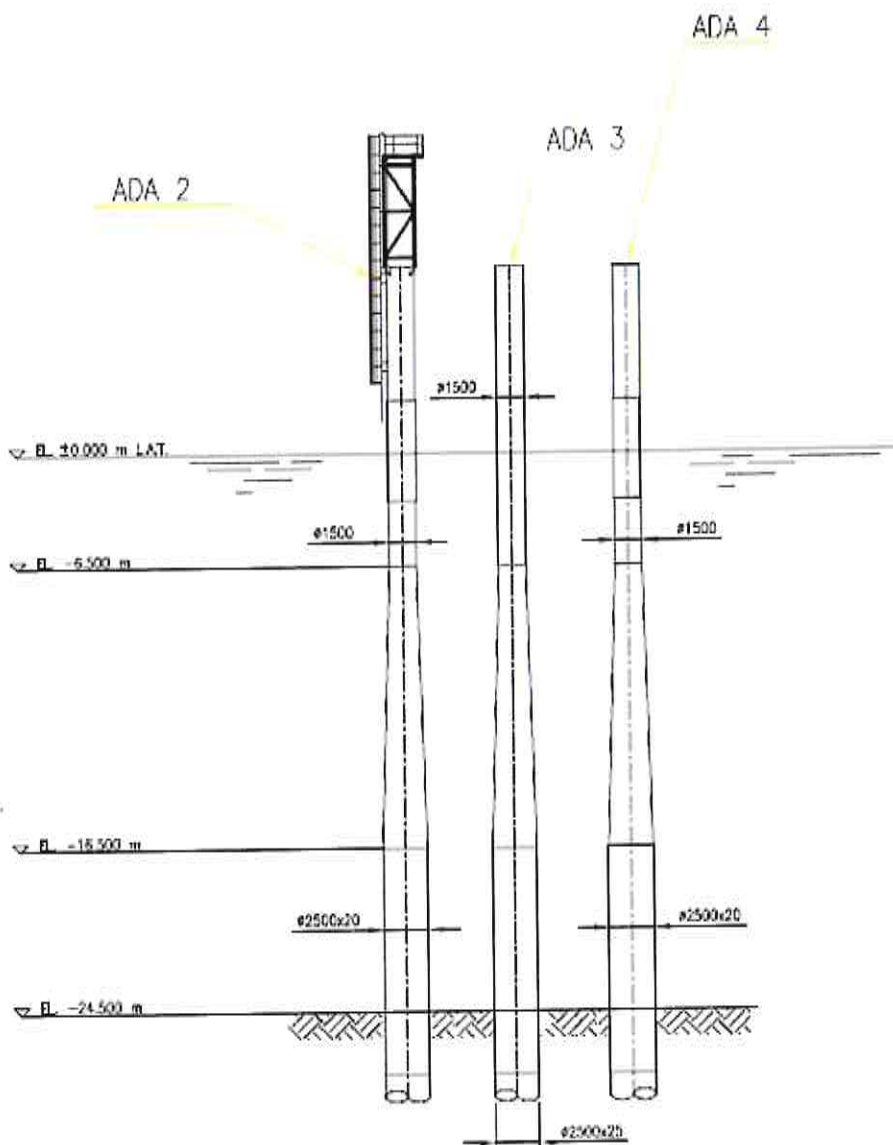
Monotubolare Ada 3 – Campo Ada – Vista Laterale
